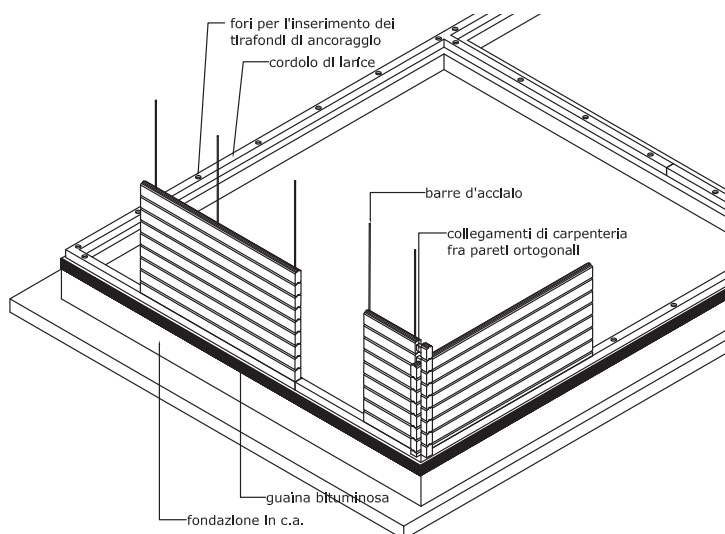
Posa delle pareti e particolare delle barre d'acciaio di collegamento del pacchetto parete e di presidio al sollevamento.
